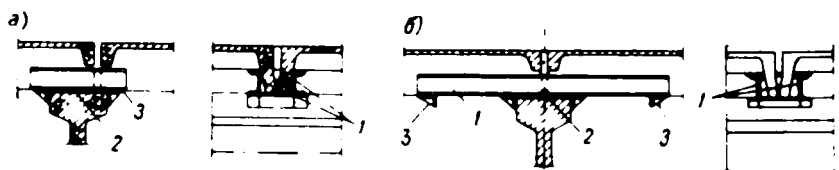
Примеры устранения дефекта опирания плит покрытий (а) и повышения несущей способности плит (б)
